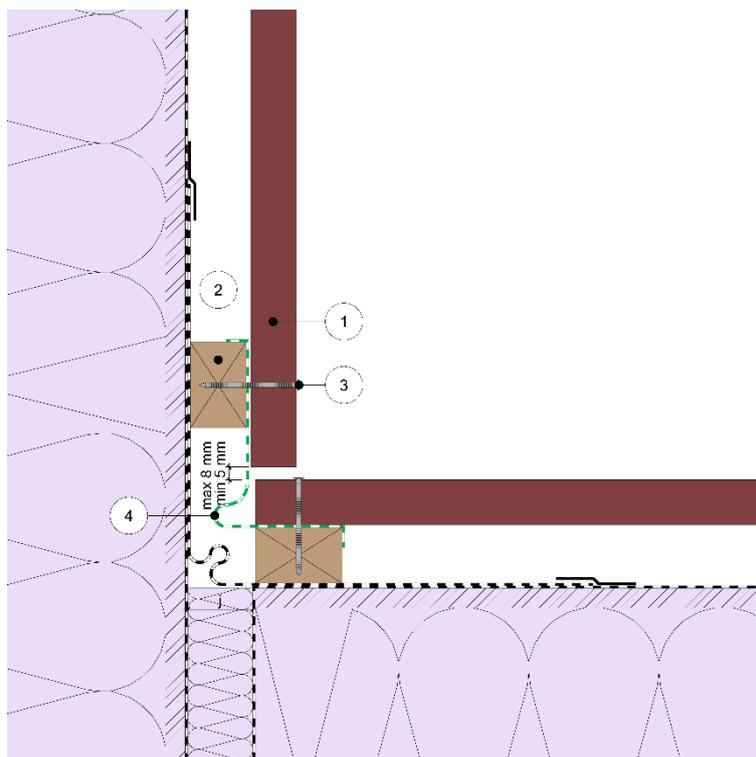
Exemple d'angle rentrant – coupe horizontale
